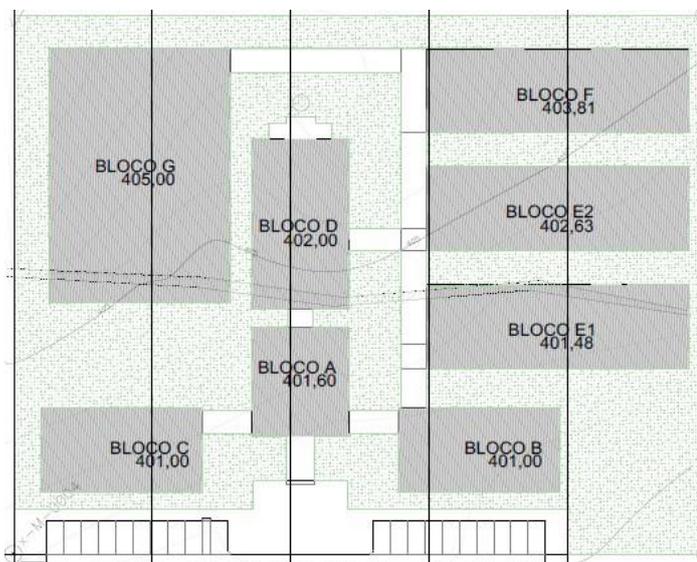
Planta Baixa de Implantação (adequada ao terreno) Fonte: PJ Construções e Terraplanagem LTDA.
